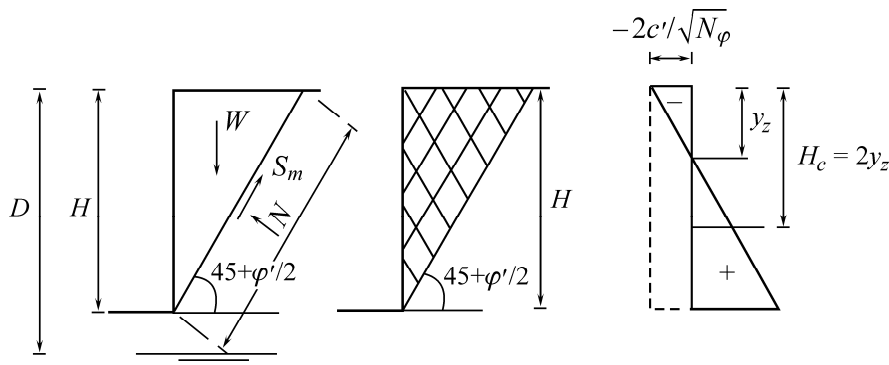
Критическая высота выемки без крепления стенок в ненасыщенном грунте
